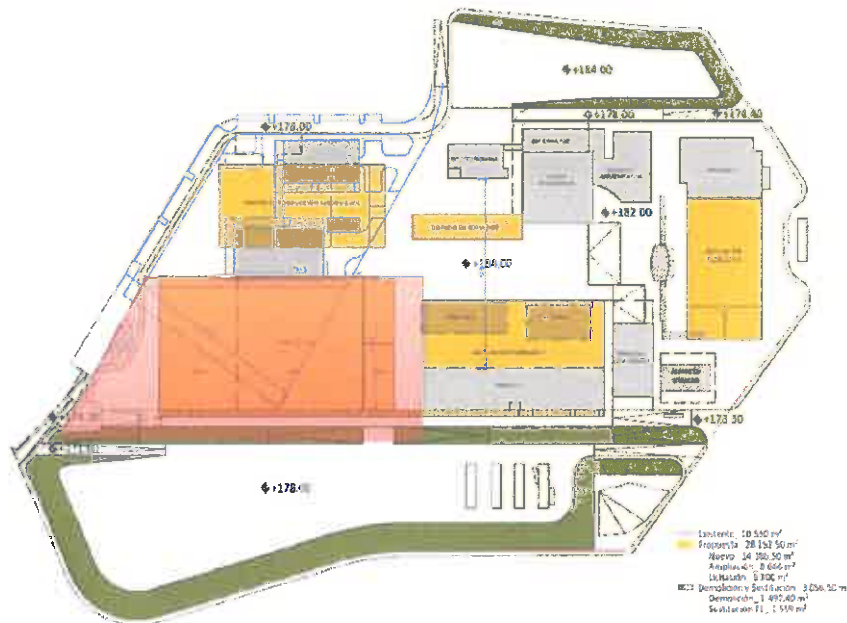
Plano de Comparación entre los volúmenes propuestos y la situación actual del Recinto Ferial.
